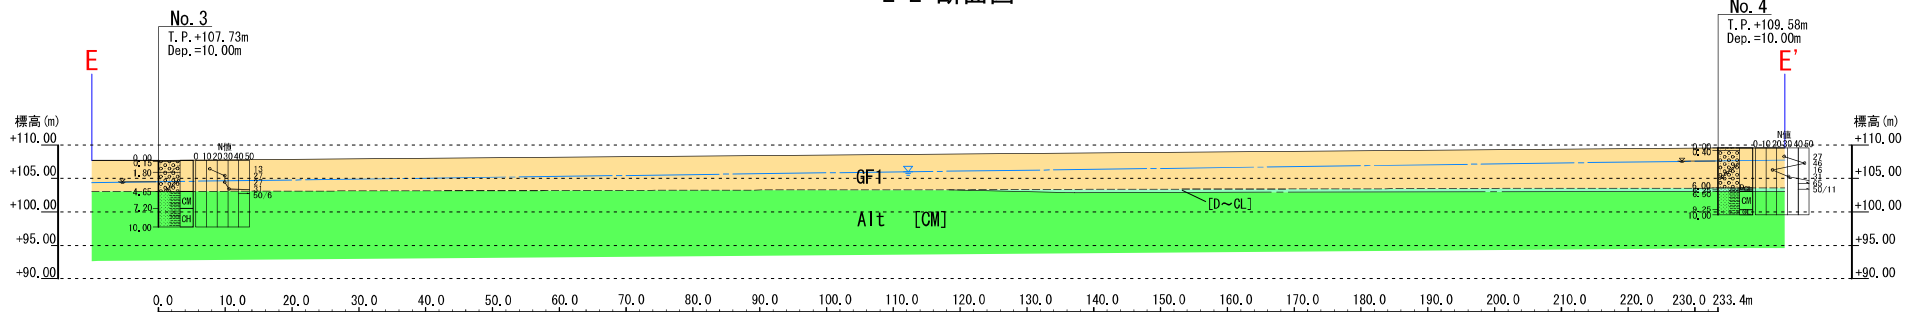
地層推定断面図 (3) [E-E' 断面図] s=1:800
